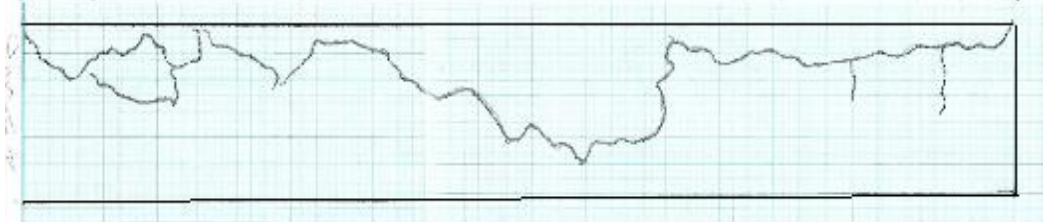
Penurunan permukaan blok beton benda uji KT-SC-04
